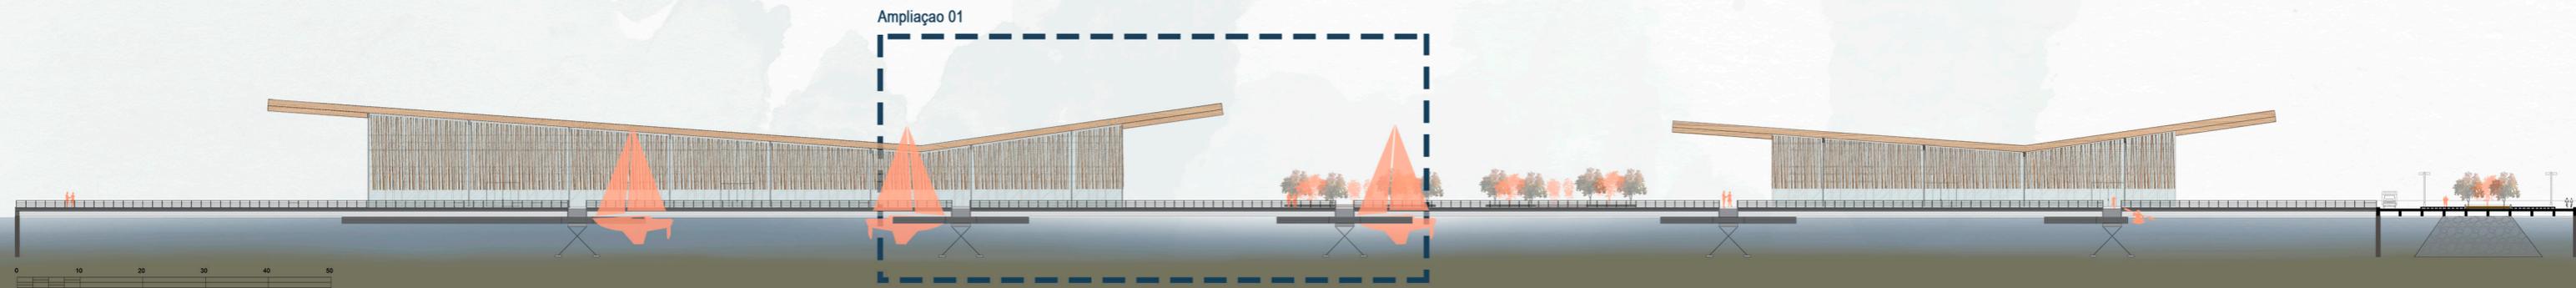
Elevação Pier. Fonte: Autora,2021.
